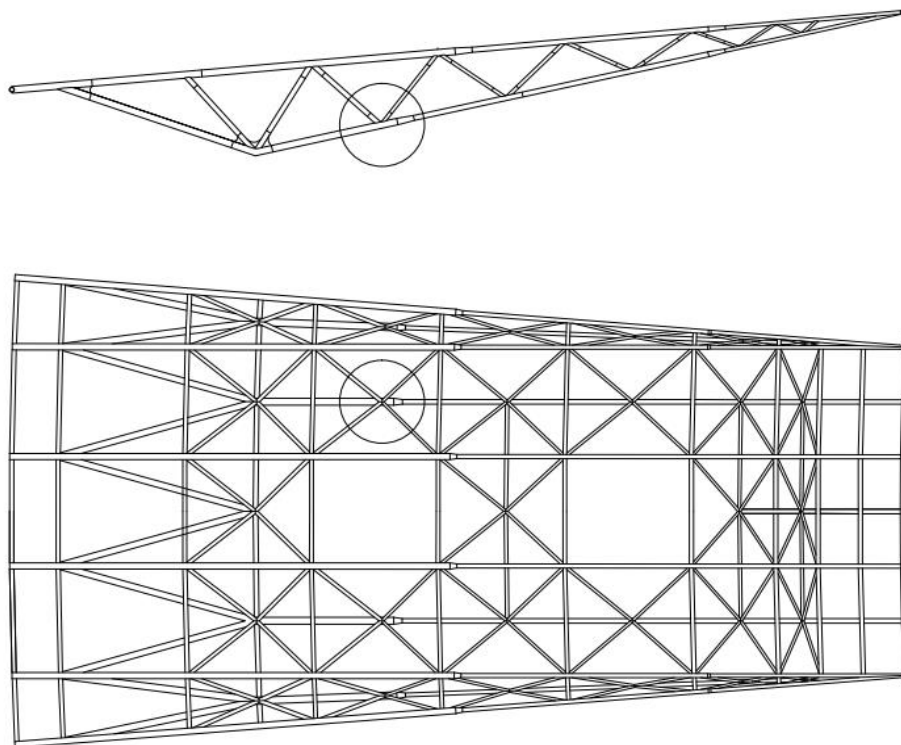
L'assemblage soudée type 2 de Nœud 2
